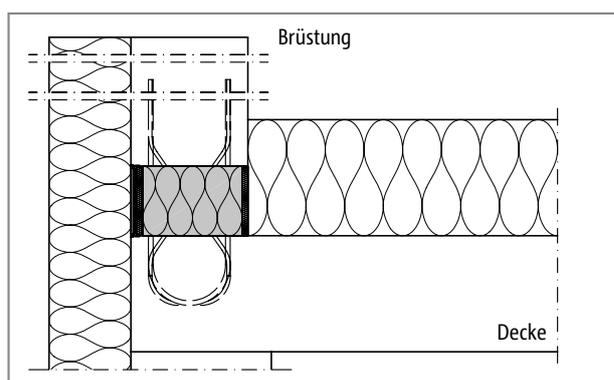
Schöck Isokorb® Typ ZXT bei EI120 mit ABXT: Brandschutzplatte oben und unten
